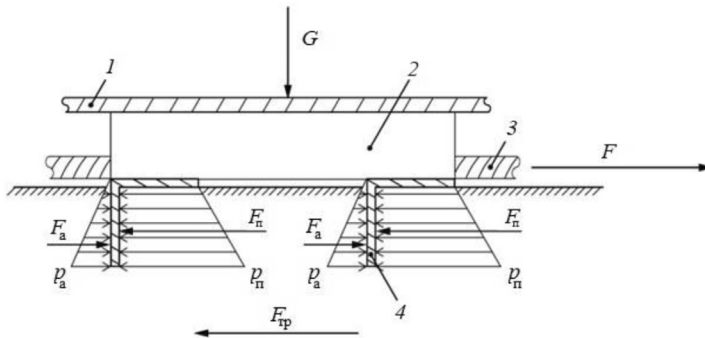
Фрагмент нижней части наполняемой мобильной гравитационно-анкерной опоры: 1 – дно наполняемой емкости; 2 – соединительный продольный элемент секции грунтозацепов; 3 – продольная гибкая связь основания опоры; 4 – грунтозацеп [6]
